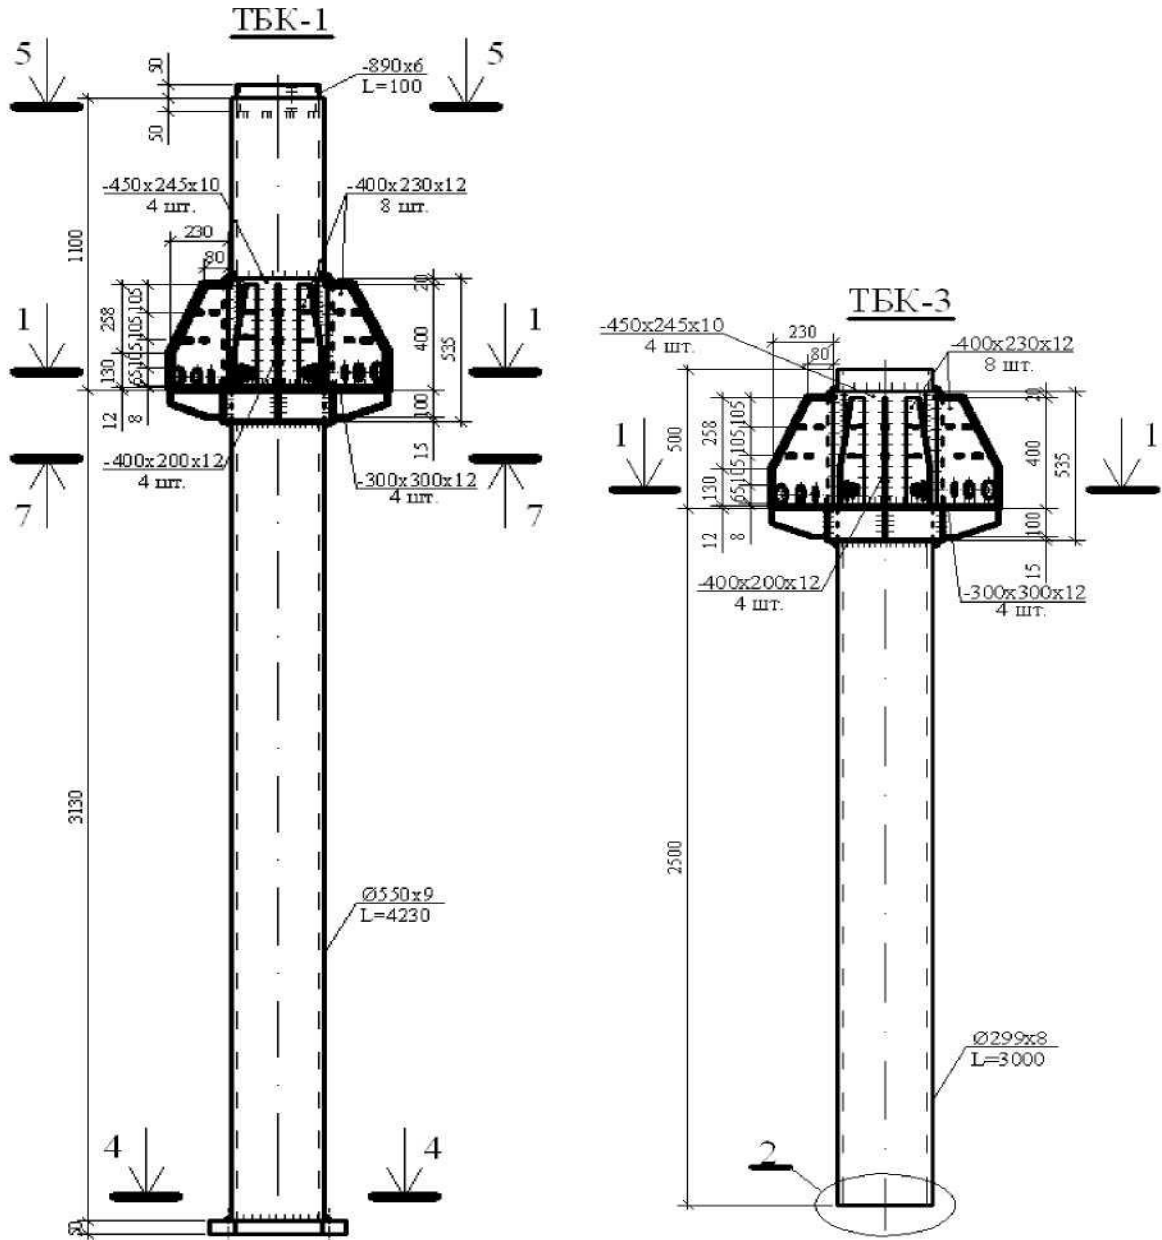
Загальний вигляд трубобетонних колон з ребрами
